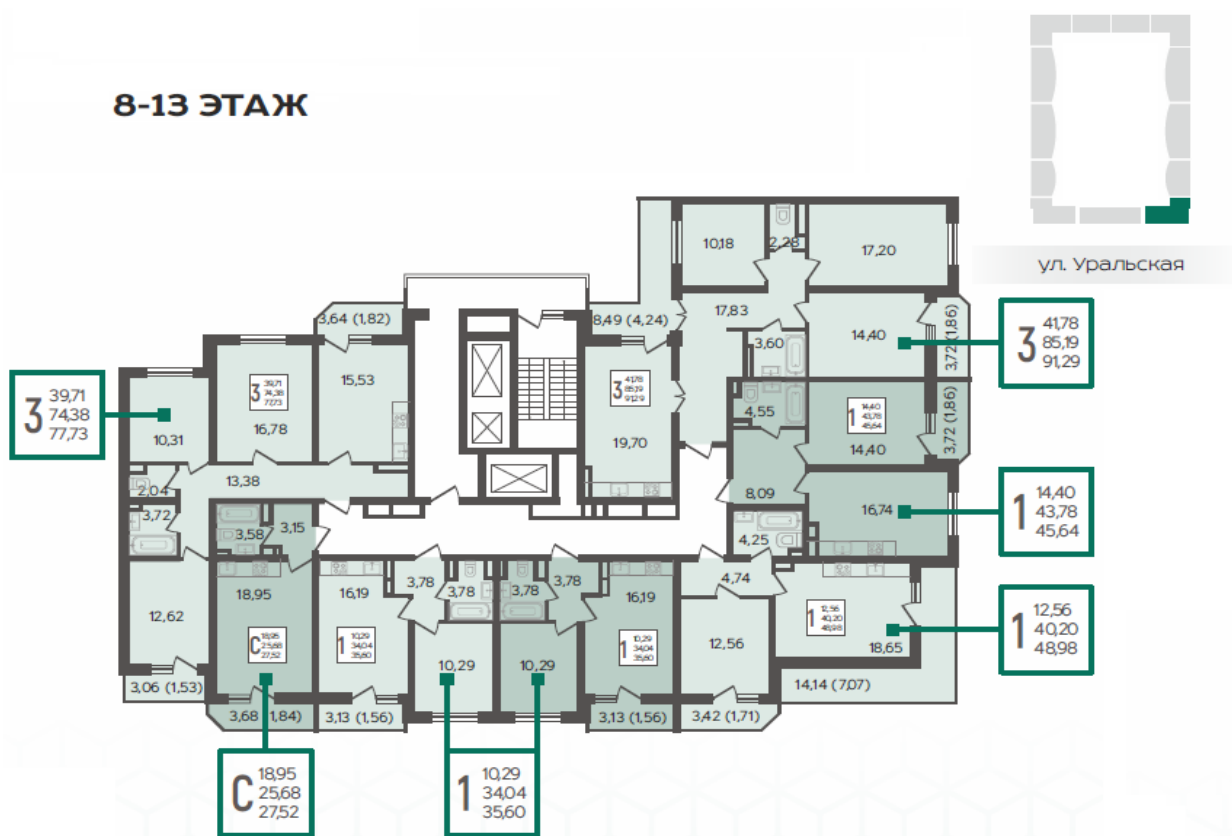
Типовой план 8-13 этажа БС-12 ЖК URAL
